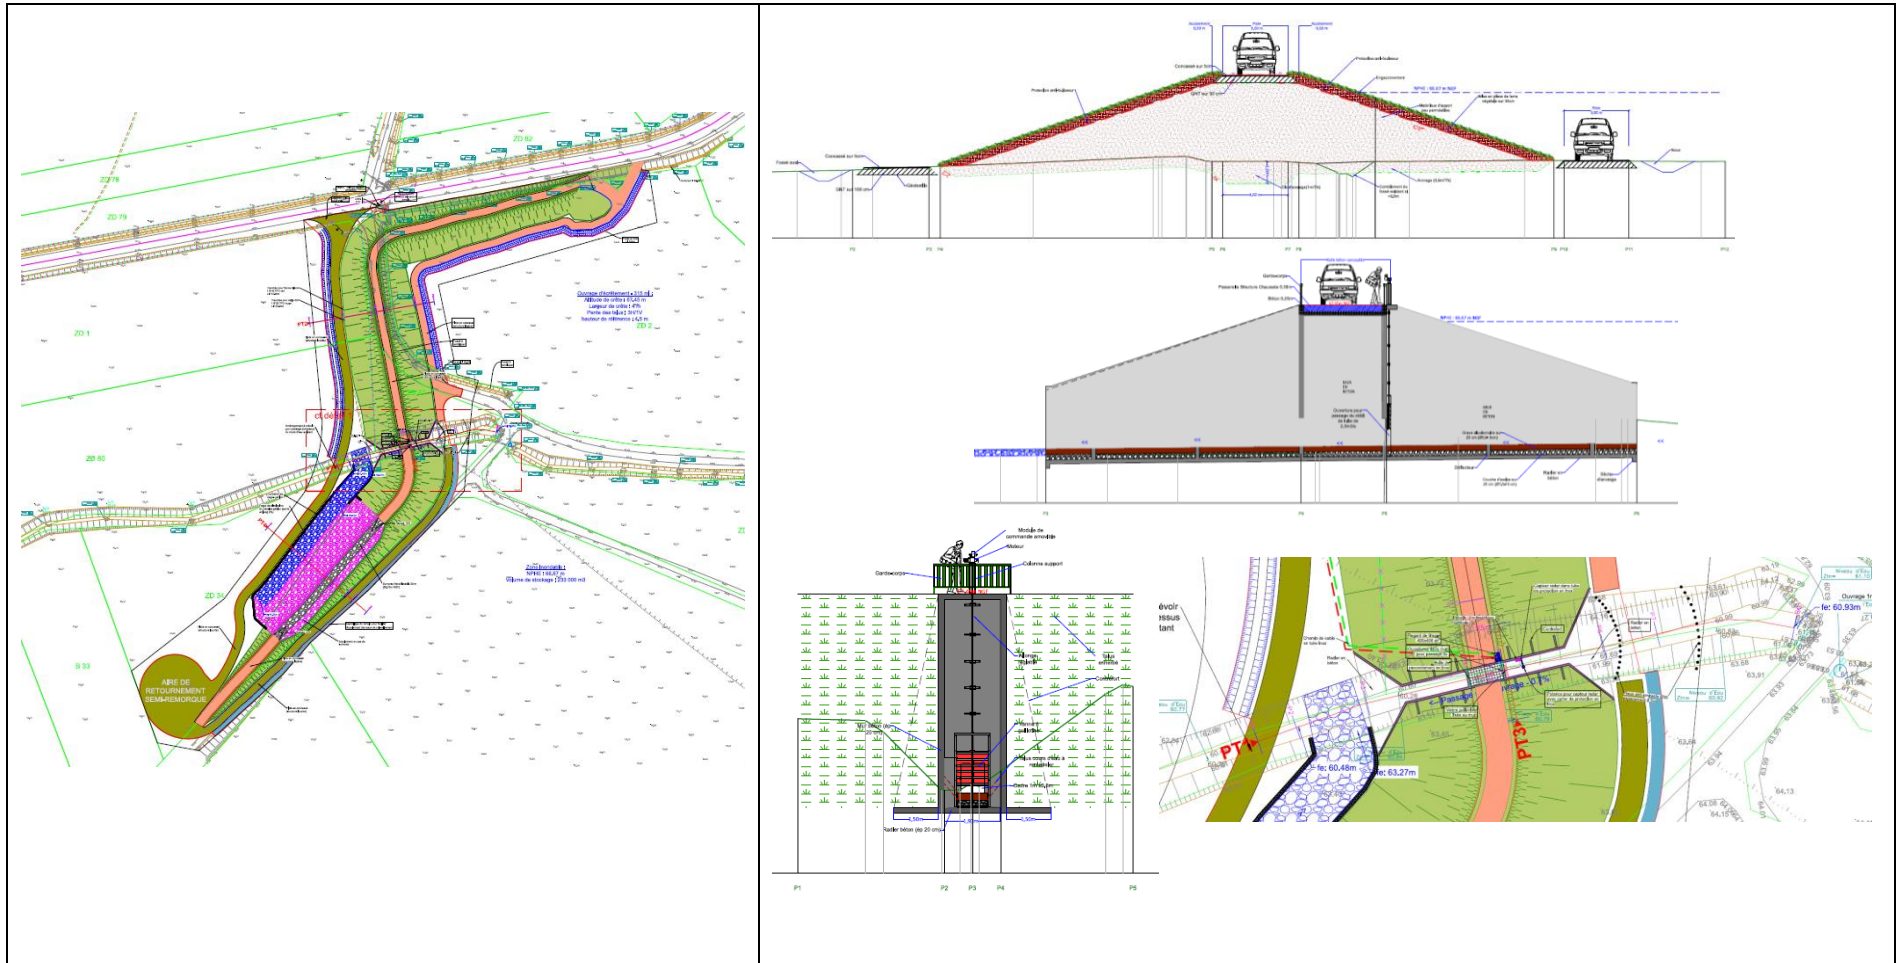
Plans et coupes de l'ouvrage de Berlancourt
